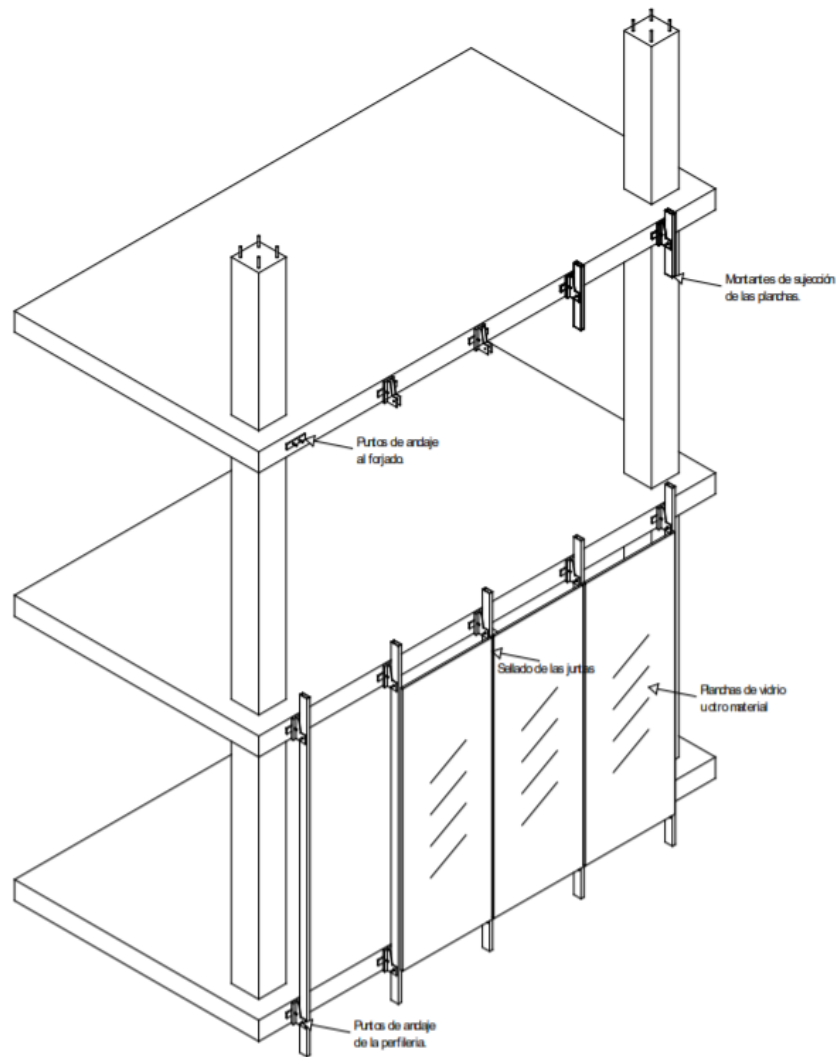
Detalle del proceso constructivo de un Muro Cortina tradicional. Fuente: (Boada 2013)
